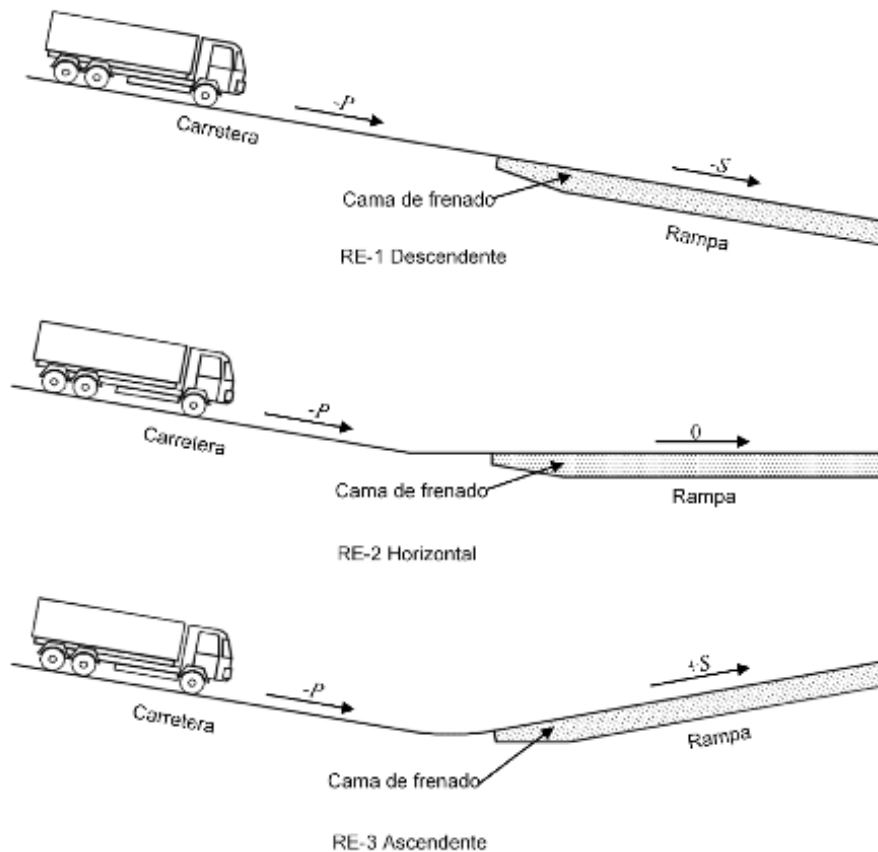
Tipos de rampas de emergencia para frenado (RE)
